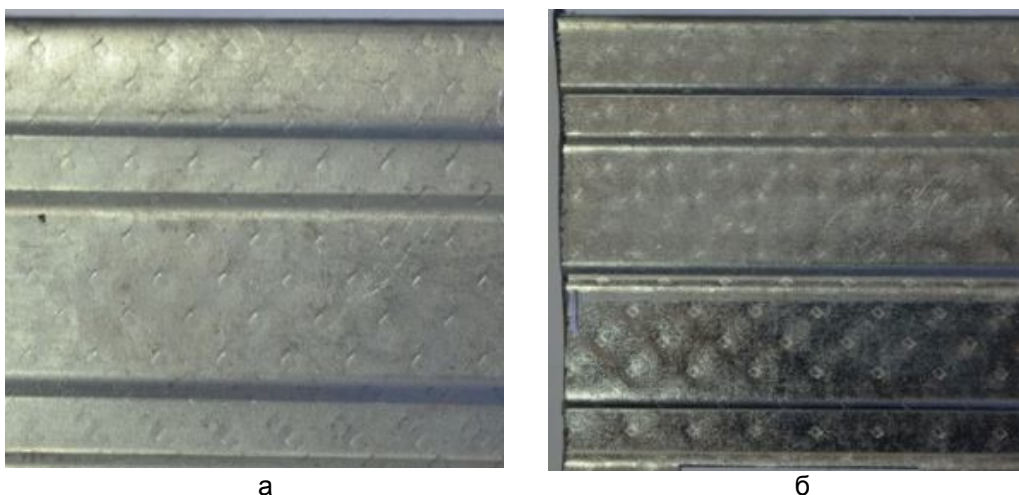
Образцы исходного профиля: а – стоечного; б – направляющего
